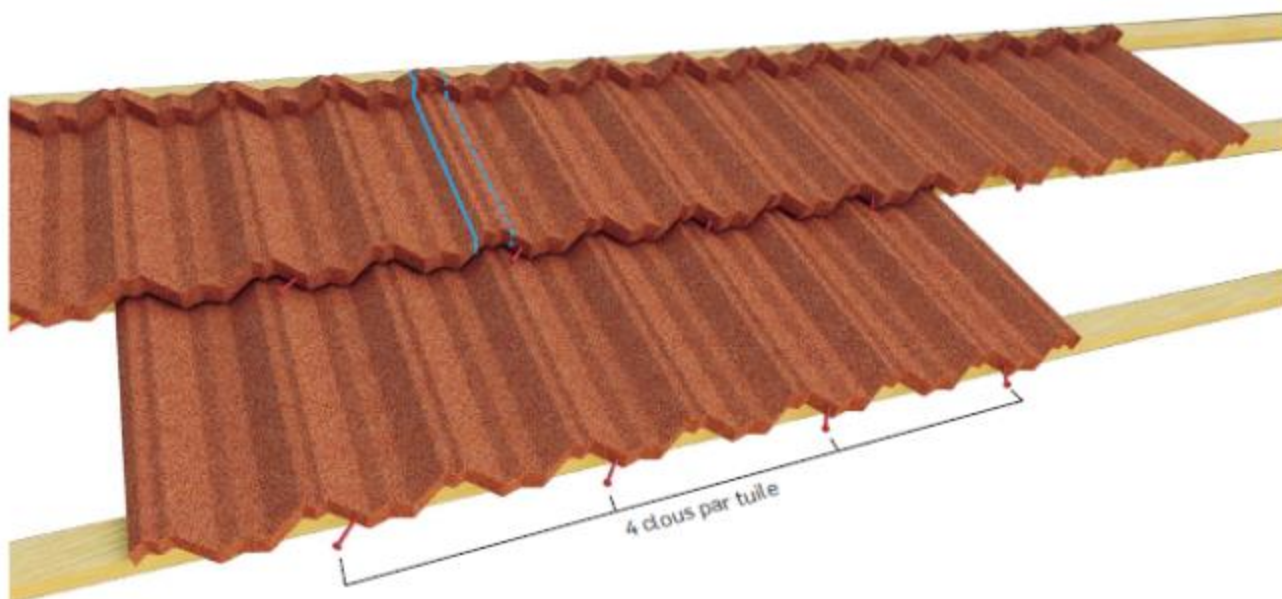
Tuile « GERARD CLASSIC », dimensions, clouage et recouvrement
